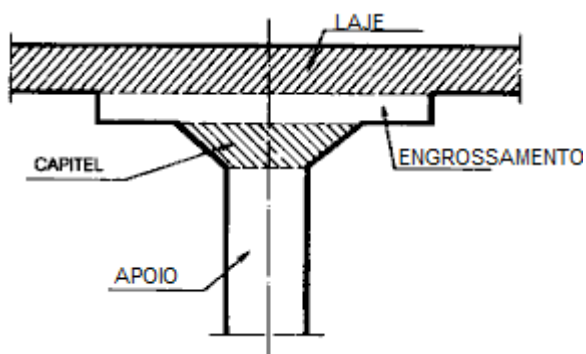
POSSÍVEIS ELEMENTOS CONSTITUINTES NUMA LIGAÇÃO PILAR-LAJE
